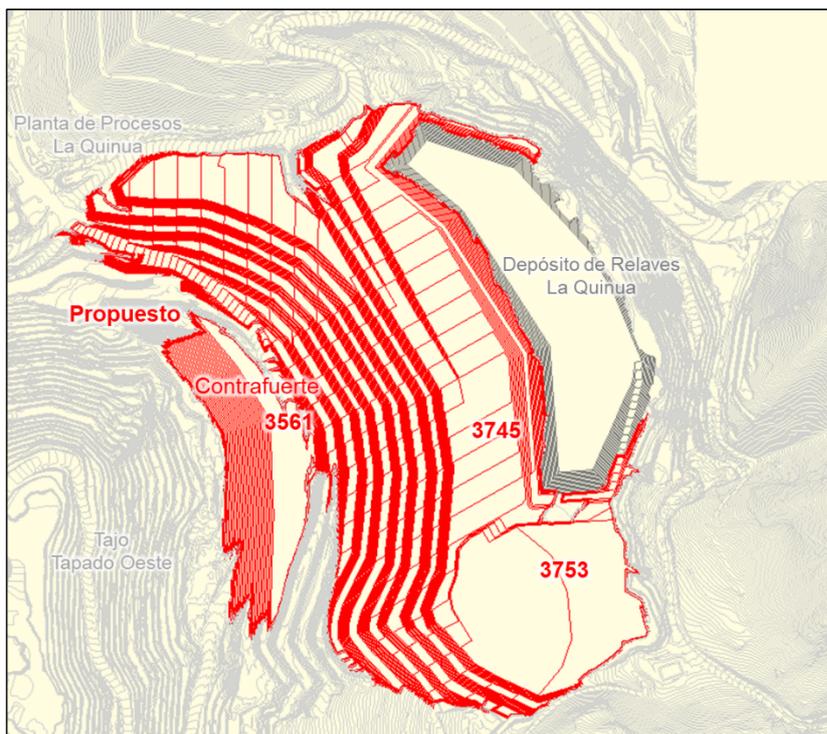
Plan de descarga del Relleno La Quinua propuesto – Año 2023 al 2025 – Vista en planta
